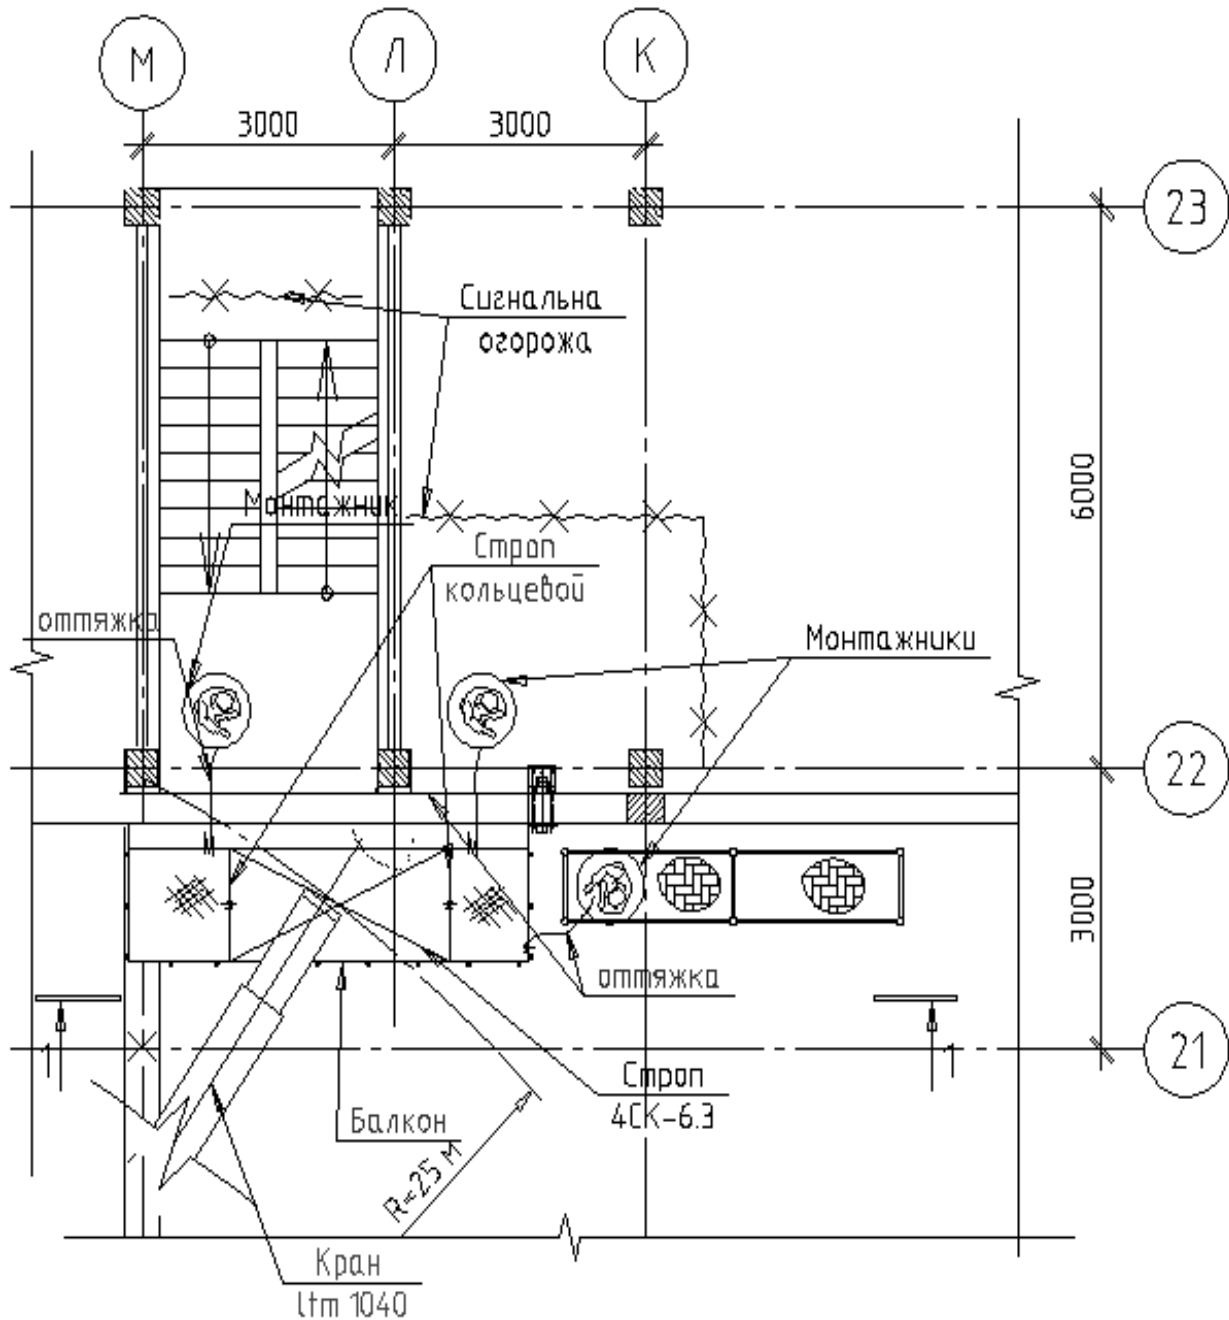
Схема выполнения работ по монтажу конструкций балконов в осях «М-К».
